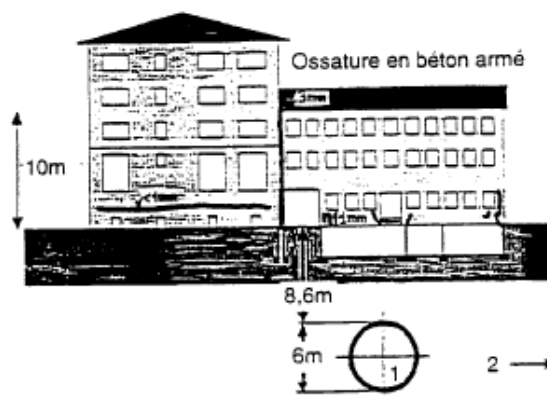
Fissuration d'immeubles en béton armé lors du creusement d'un tunnel. (Magnan 2000).
